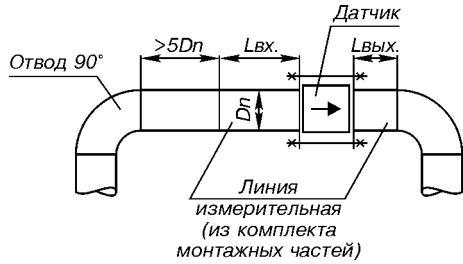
Установка в газопровод (паропровод) с отводом 90°.
